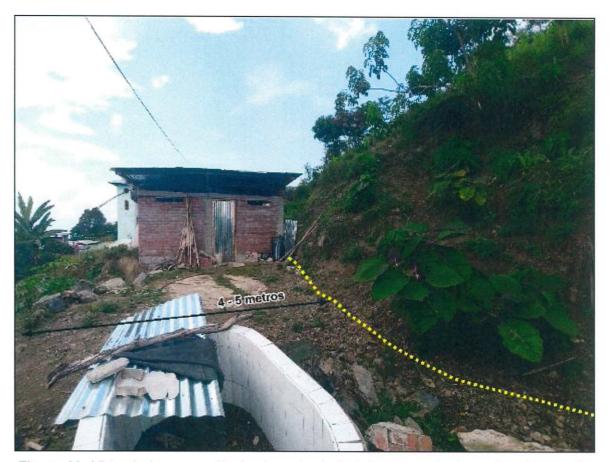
Vista de la excavación inadecuada de la ladera a modo de explanada para la construcción de viviendas.
